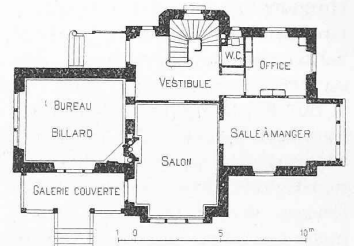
Maison de Reynier. Plan du rez-de-chaussée. — 1:400.
